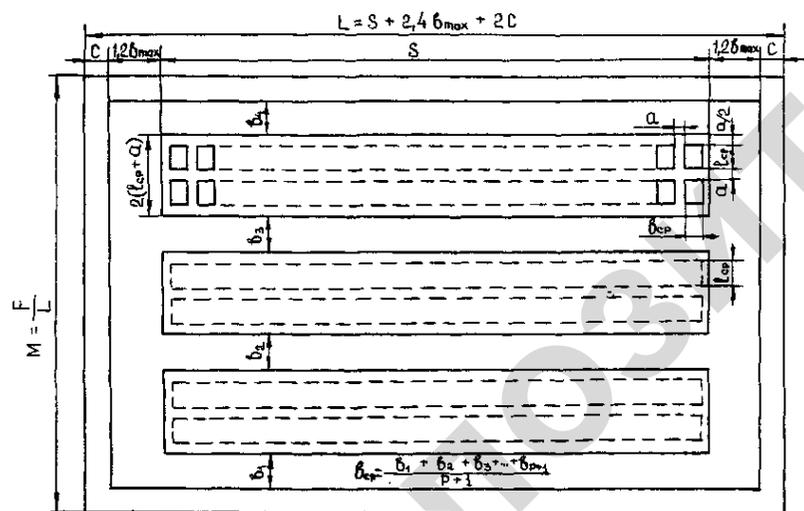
Схема для расчета открытых площадок для хранения сельскохозяйственной техники при двухрядном размещении машин
